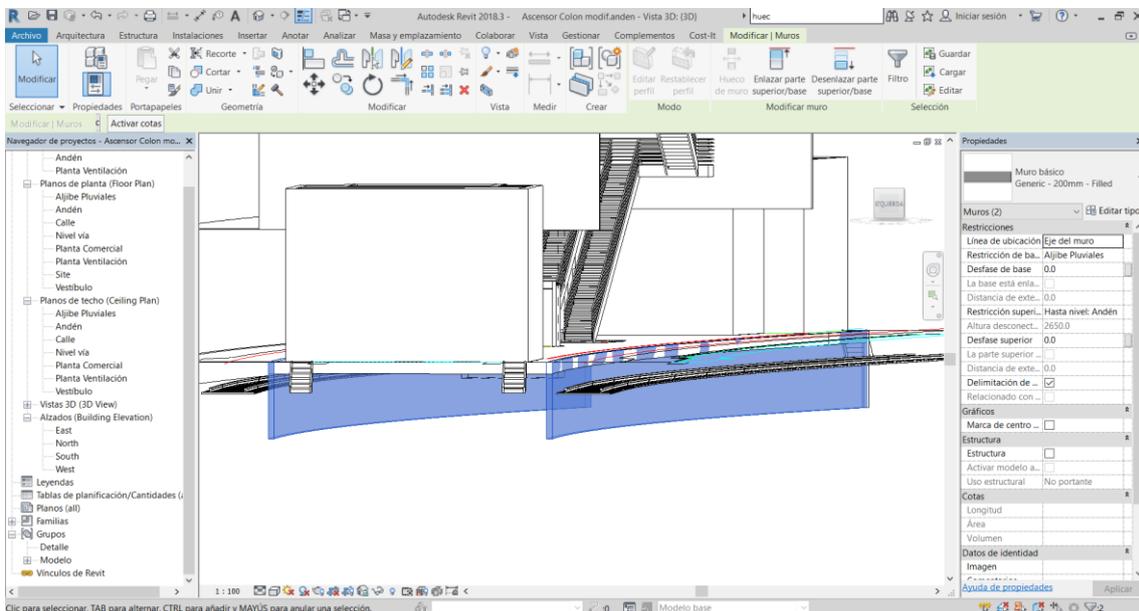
Representación de los muros estructurales bajo andén en Revit.
